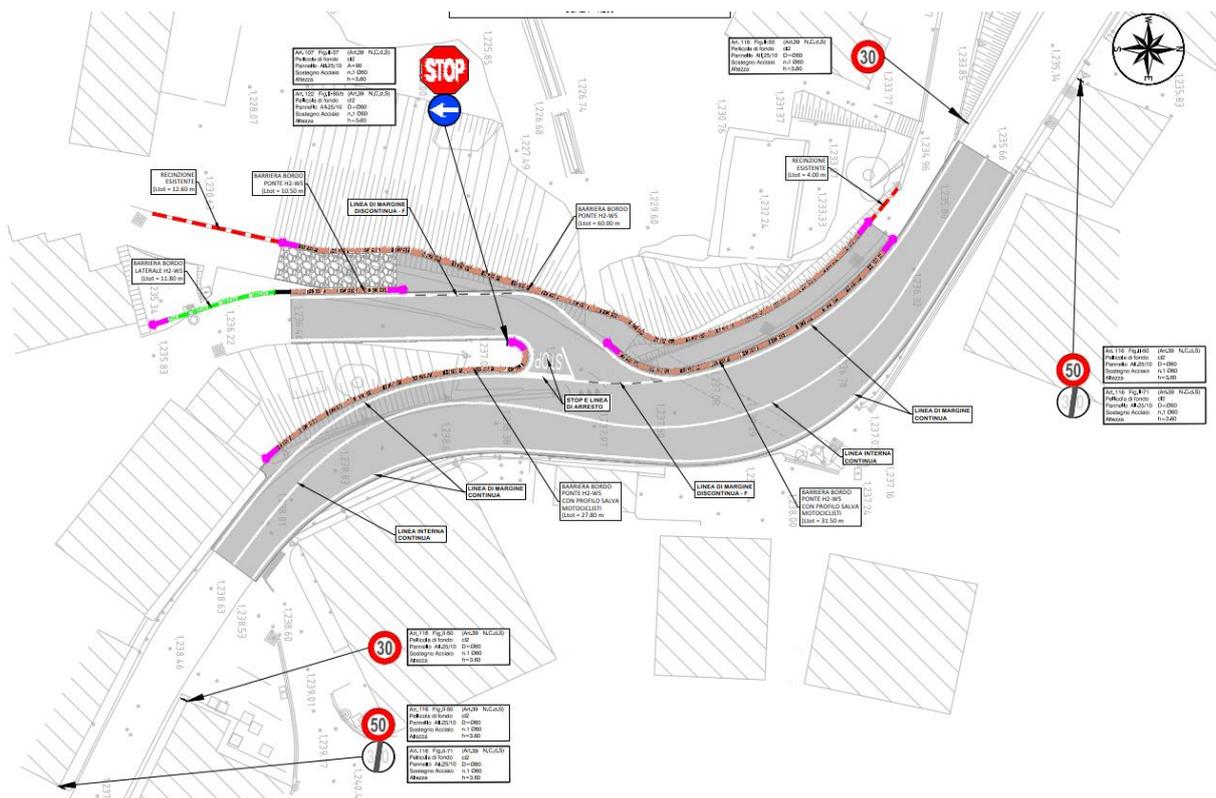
stralcio planimetrico segnaletica e barriere di sicurezza
